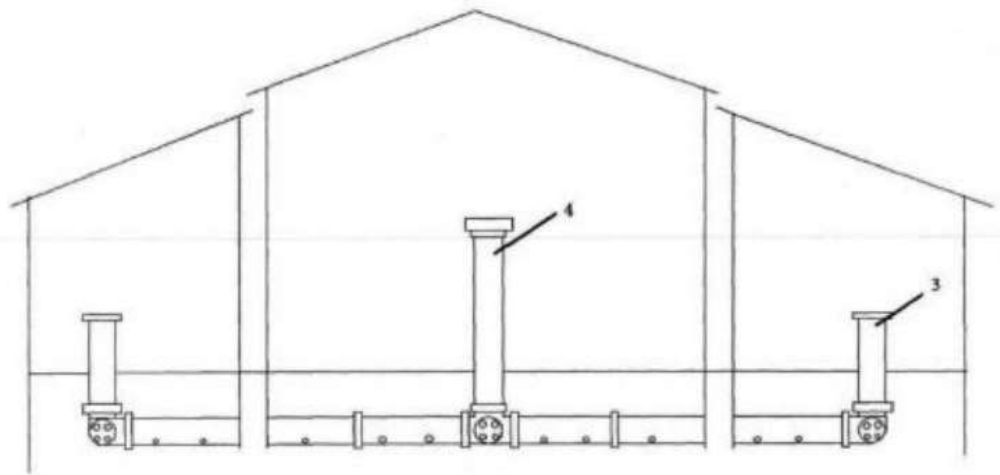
Схематичне зображення схеми вентиляції на парнику
